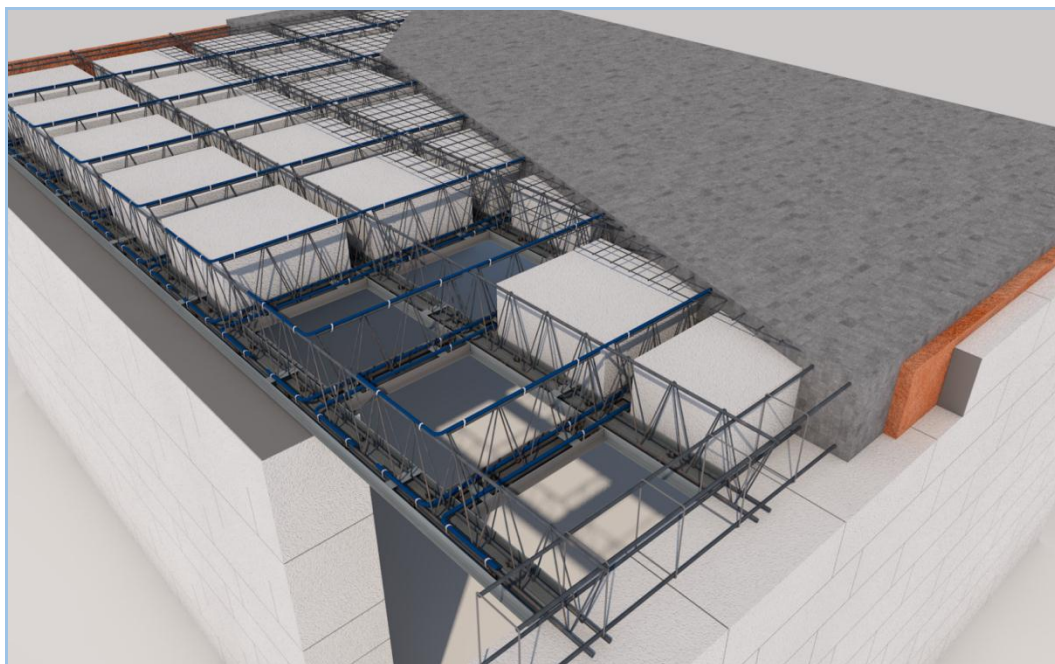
Перекрытия МАРКО-КЕССОН с блоками из газобетона
